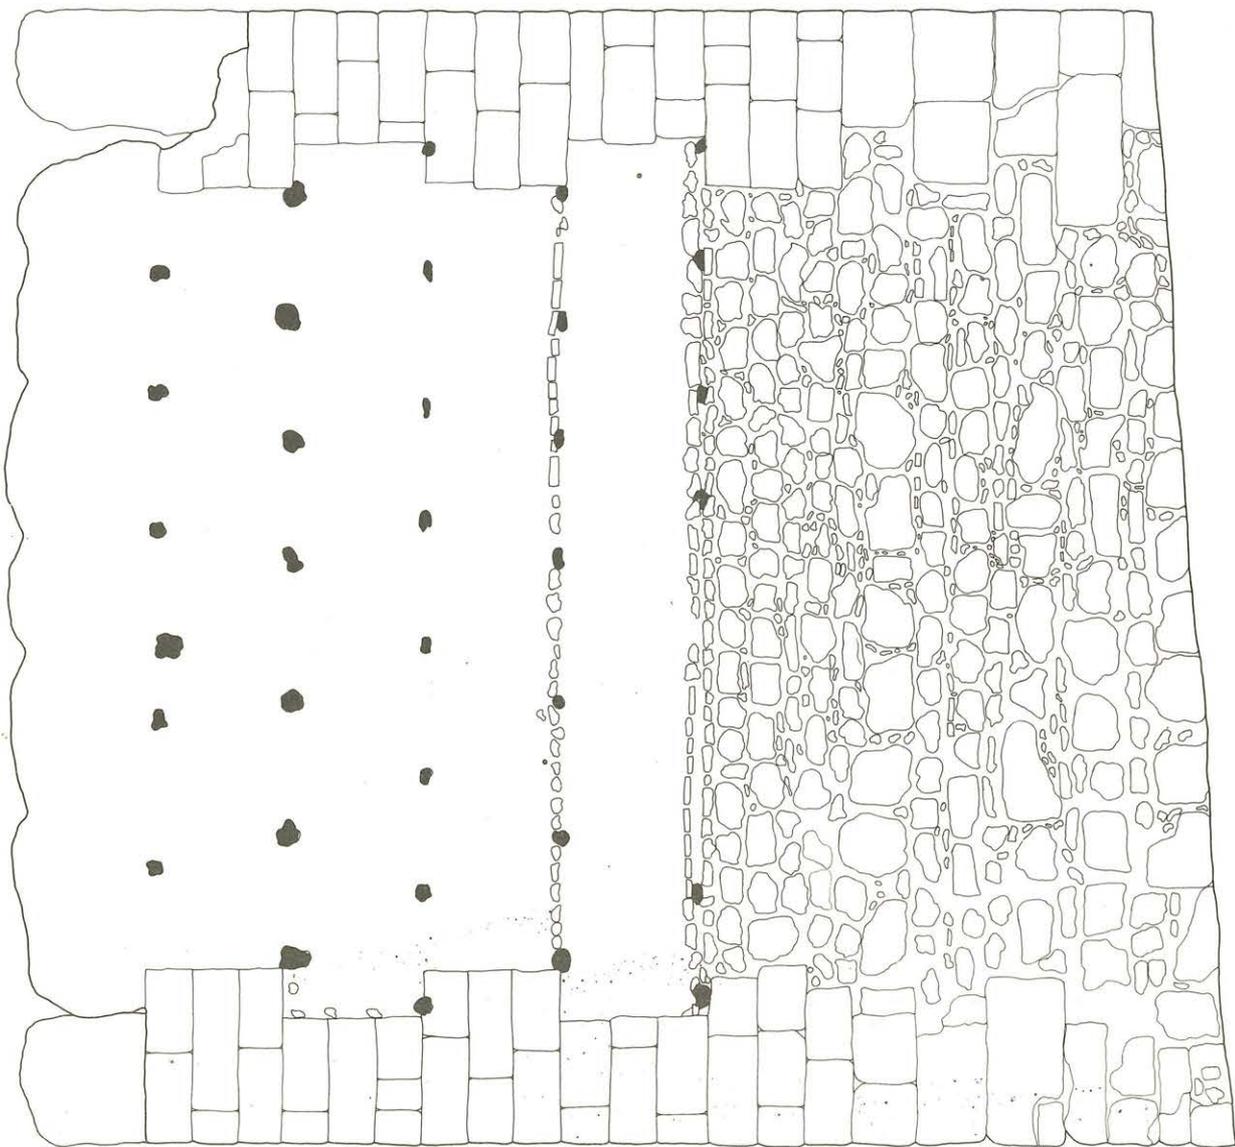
Alzado sur de la Torre A. Ibidem autor.
